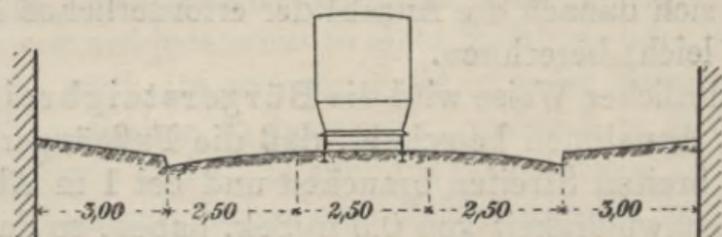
Querprofil mit eingleisiger Straßenbahn.
